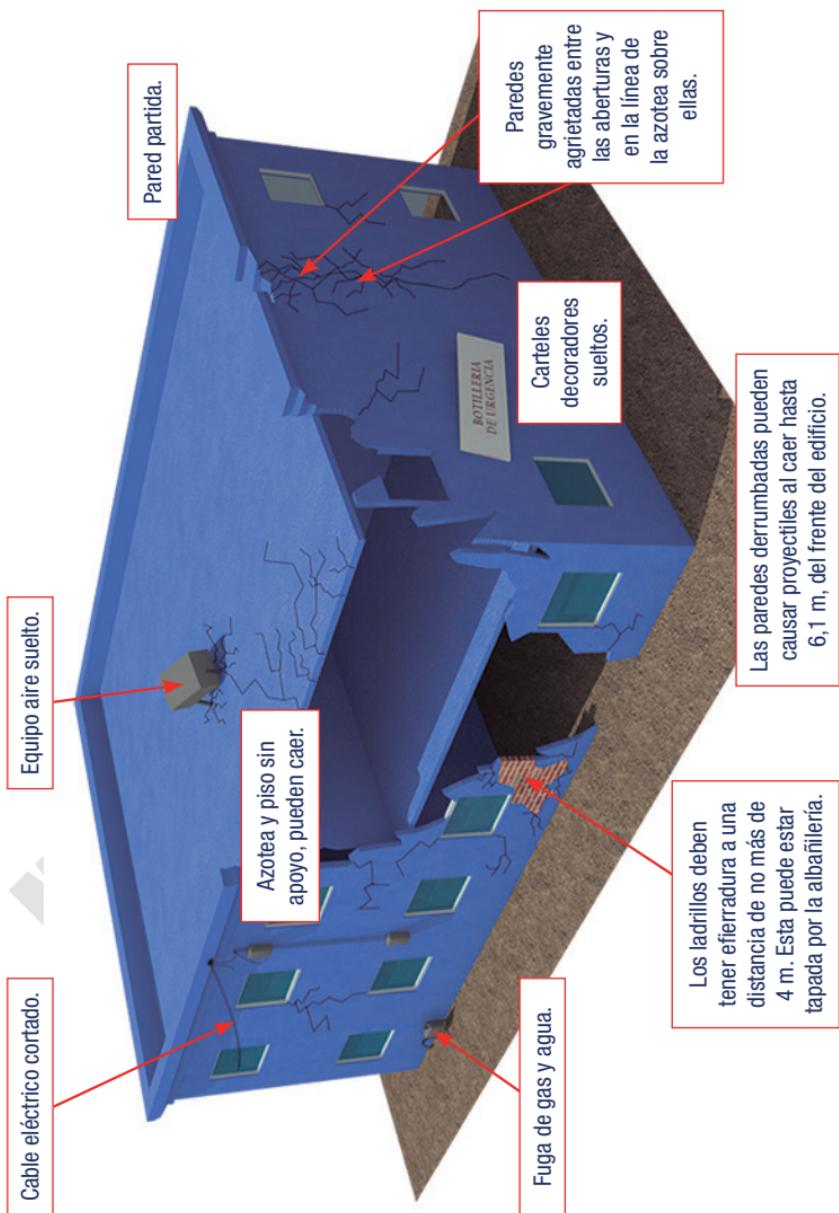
Peligros al evaluar construcciones de albañilería no reforzada o muros pesados.
